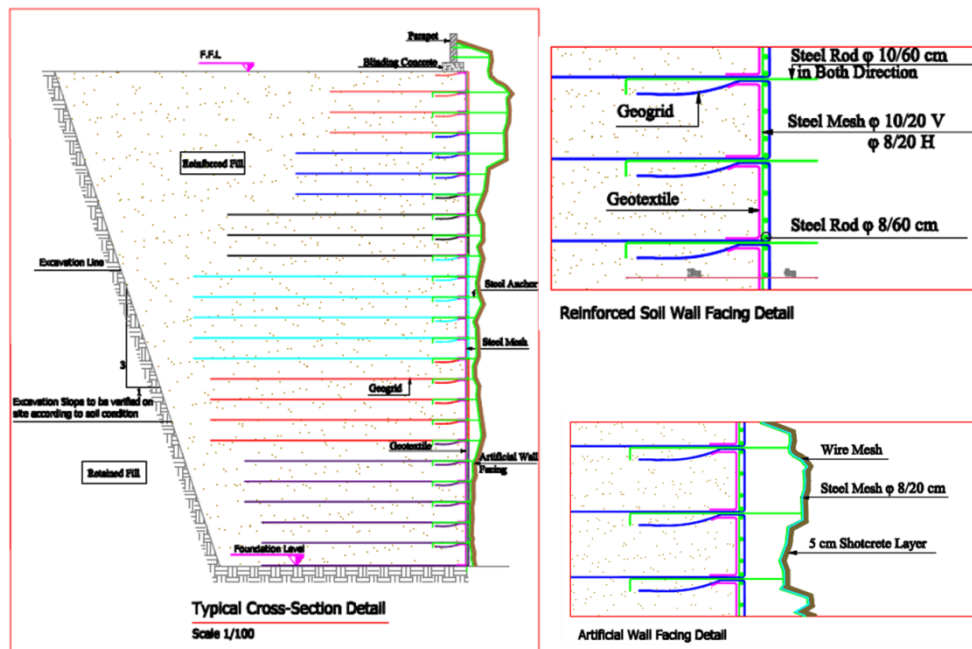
Sección transversal típica de un muro de suelo reforzado con envoltura de la geomalla y revestimiento con concreto proyectado sobre malla metálica.
